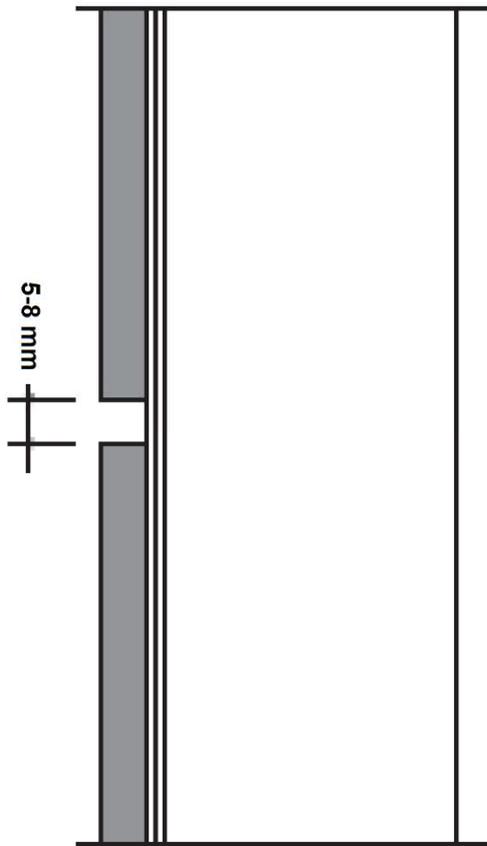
Coupe verticale sur joint horizontal (joint fermé)
